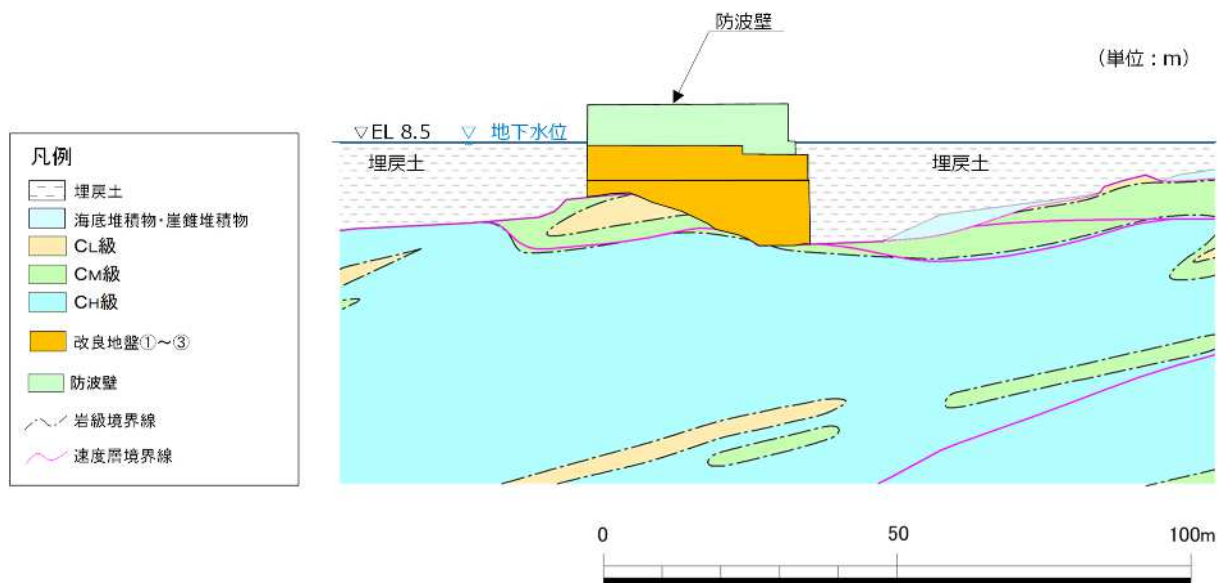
防波壁（逆T擁壁）の横断面図（⑦-⑦断面）
